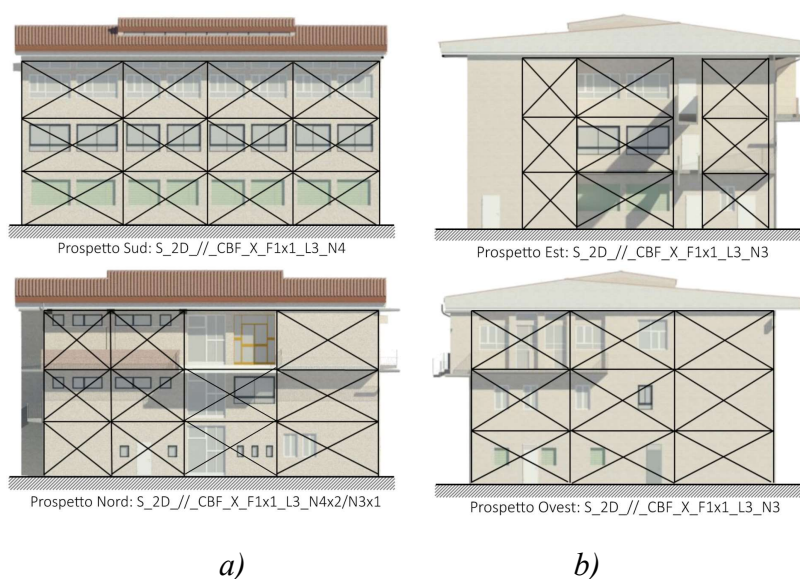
Posizionamento in prospetto degli esoscheletri: a) direzione x; b) direzione y
